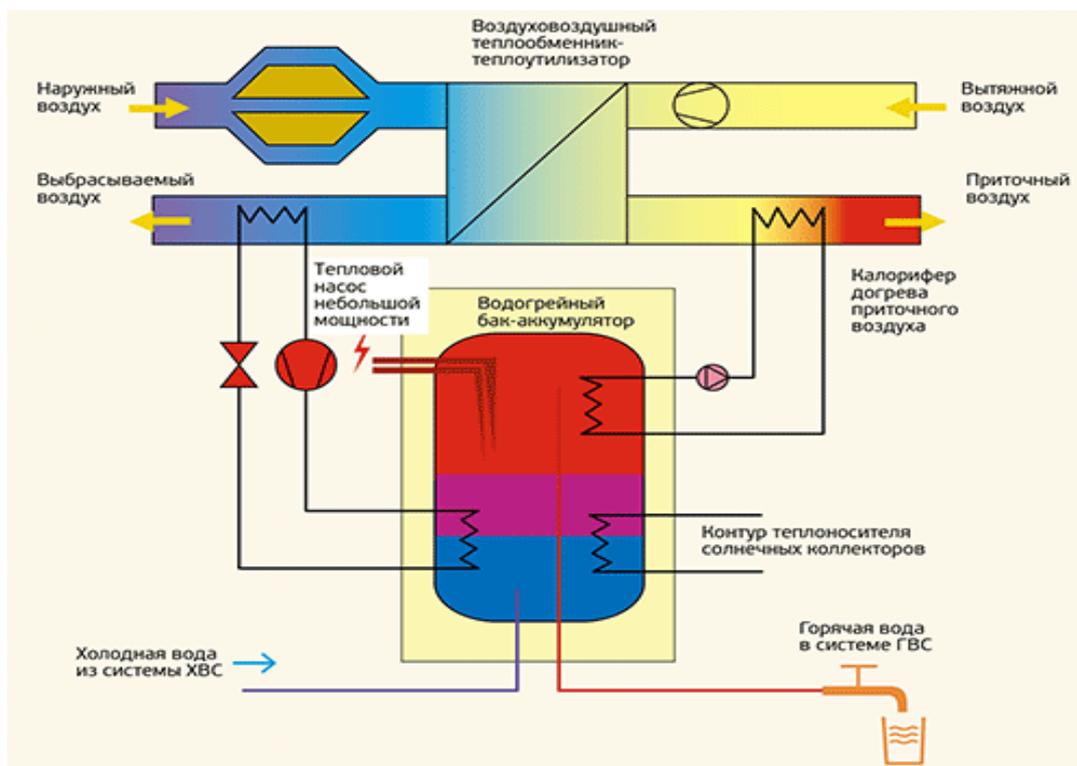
Схема единой комбинированной установки отопления, вентиляции и горячего водоснабжения пассивного здания
